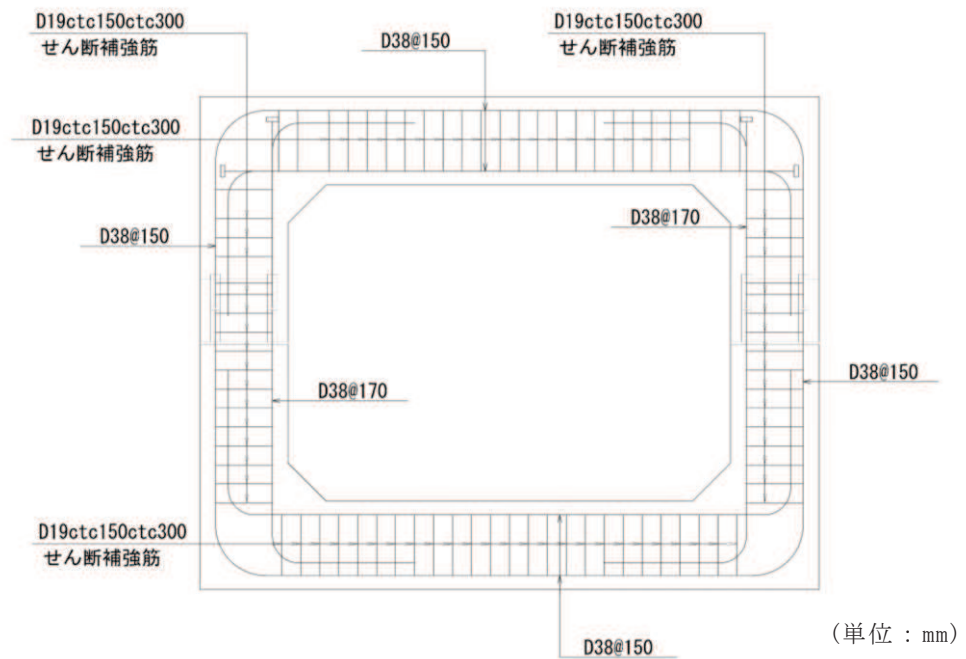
北側排水路の概略配筋図 (A-A 断面, B-B 断面共通)
